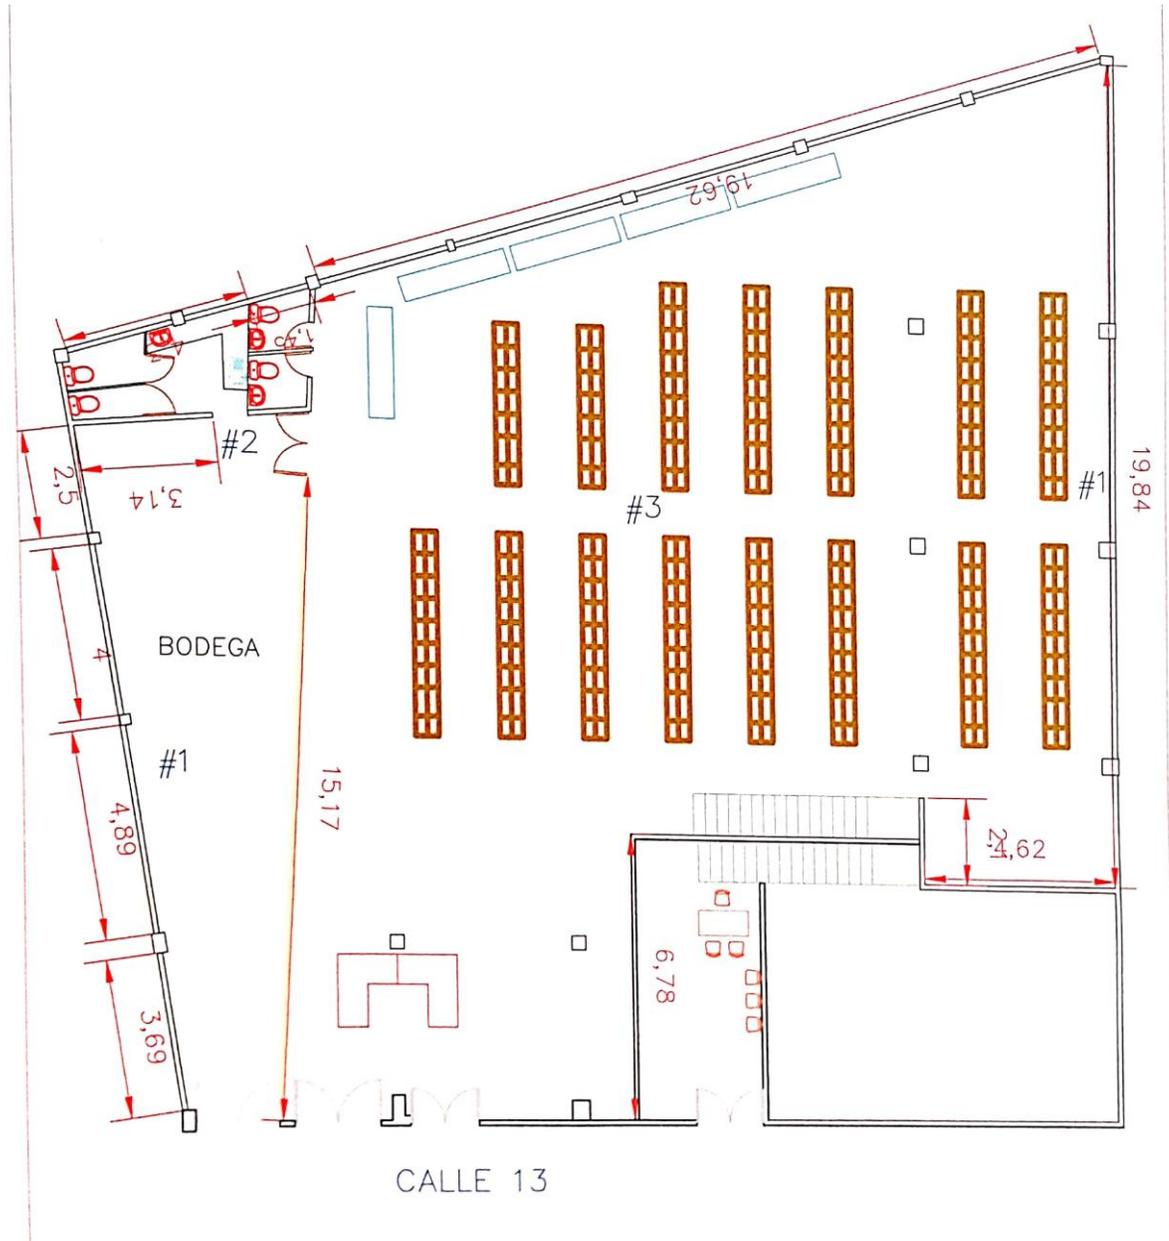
Plano arquitectónico sede Supermercado Sabana de Torres.
